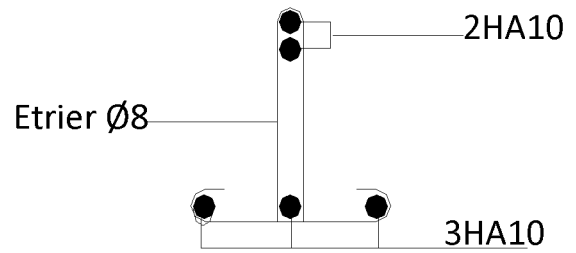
Plan de ferrailage de la poutrelle au niveau des appuis.
